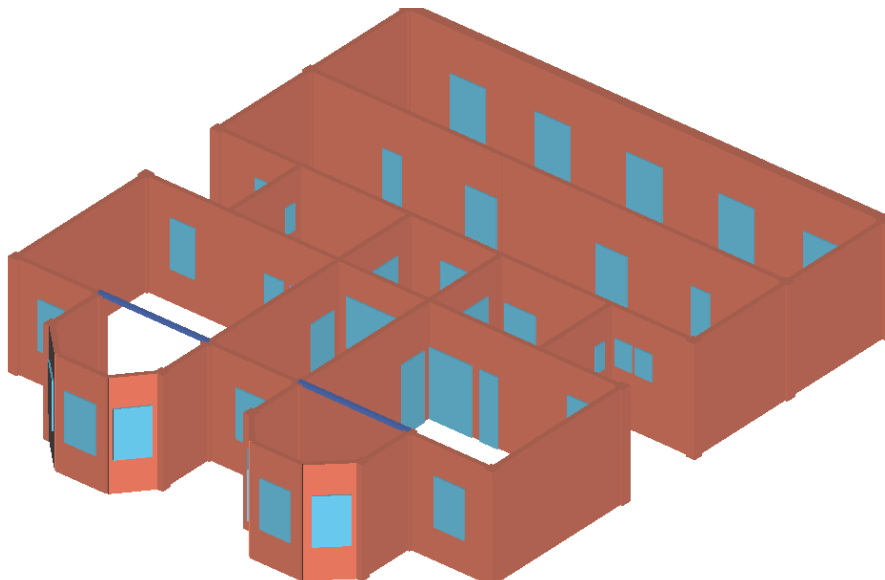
11 Vista en perspectiva de las aberturas de la planta tipo
